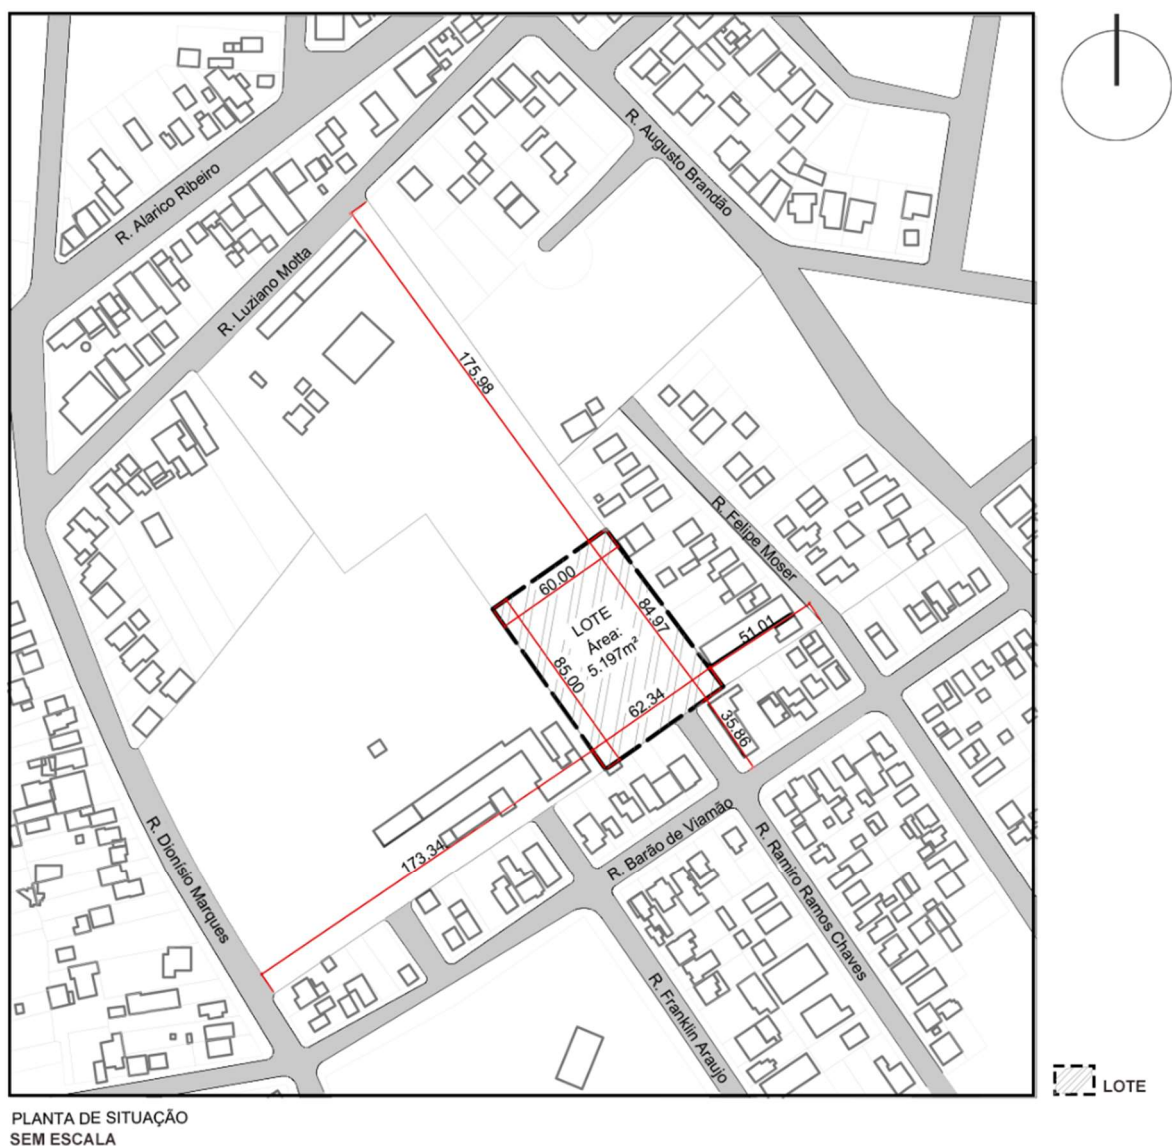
Planta de situação. Fonte: Elaborado pela autora.
